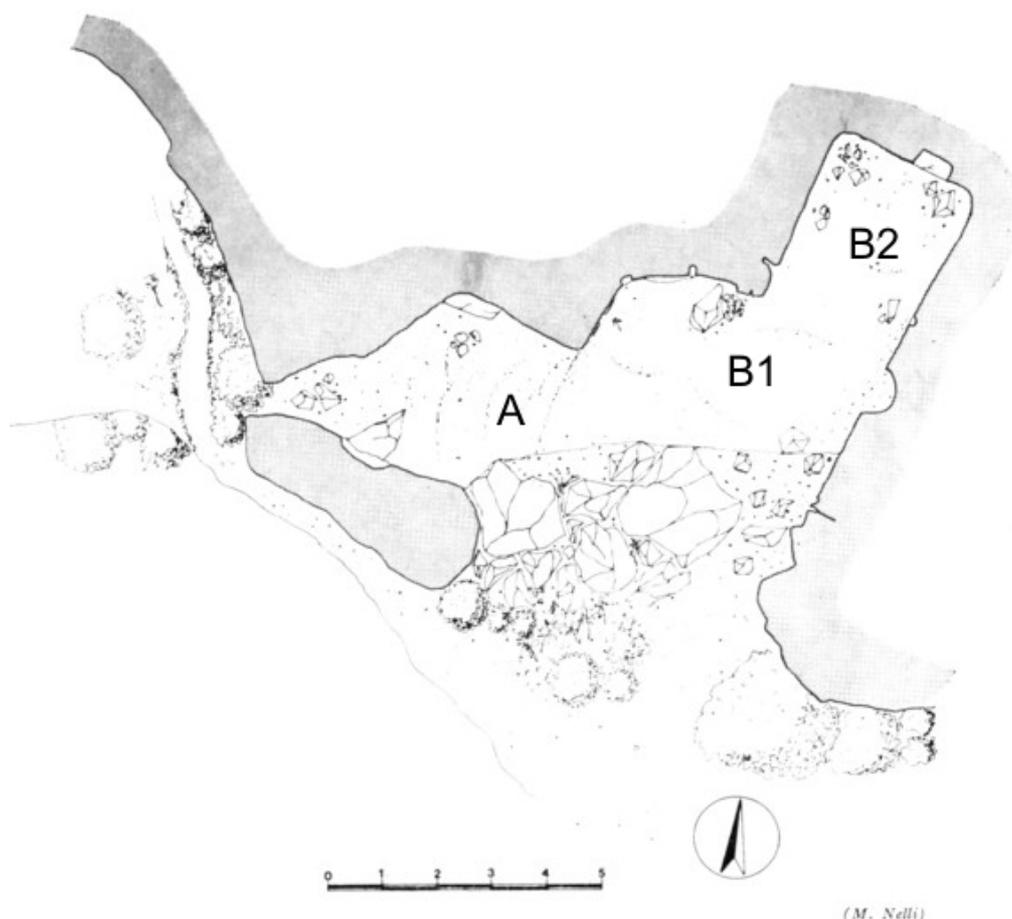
Chiesa rupestre di Vignanello, planimetria (fonte: Raspi Serra 1976, modificato dall'autore).
